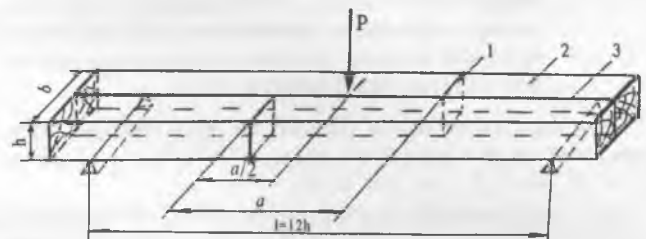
Образец клеёной конструкции: 1 – стык; 2 – элемент (рейка); 3 – клеевой шов
